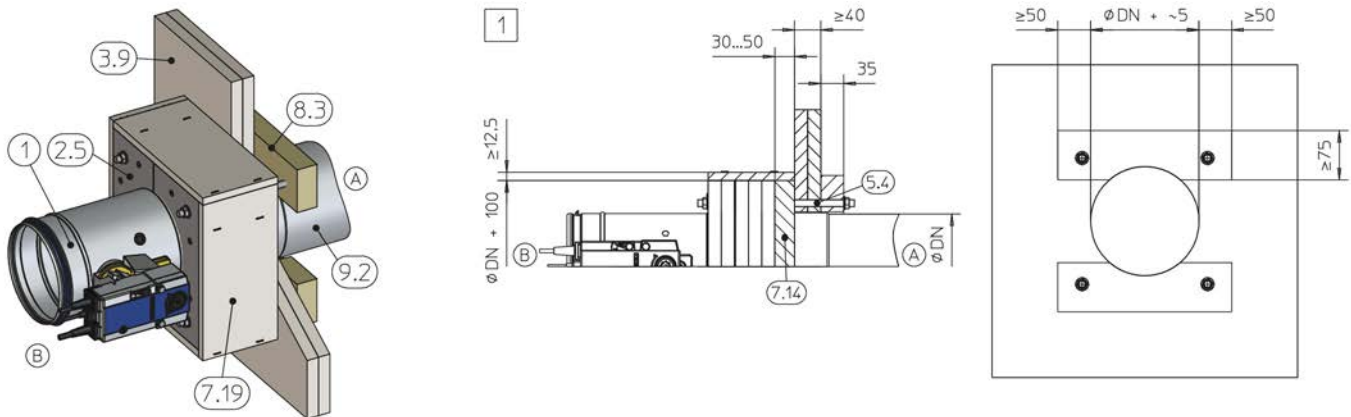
Монтаж без применения строительного раствора с монтажным комплектом TQ / TQ2 в стенах шахт без металлического каркаса
